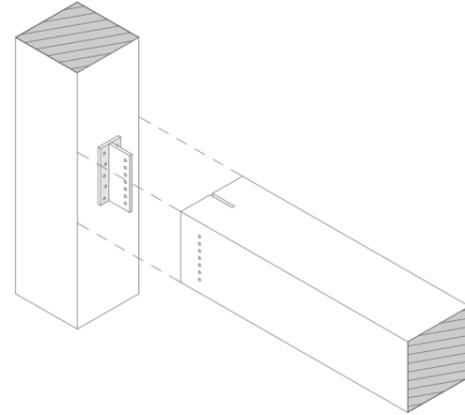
Detalle unión columna-viga. Fuente: Elaboración propia
